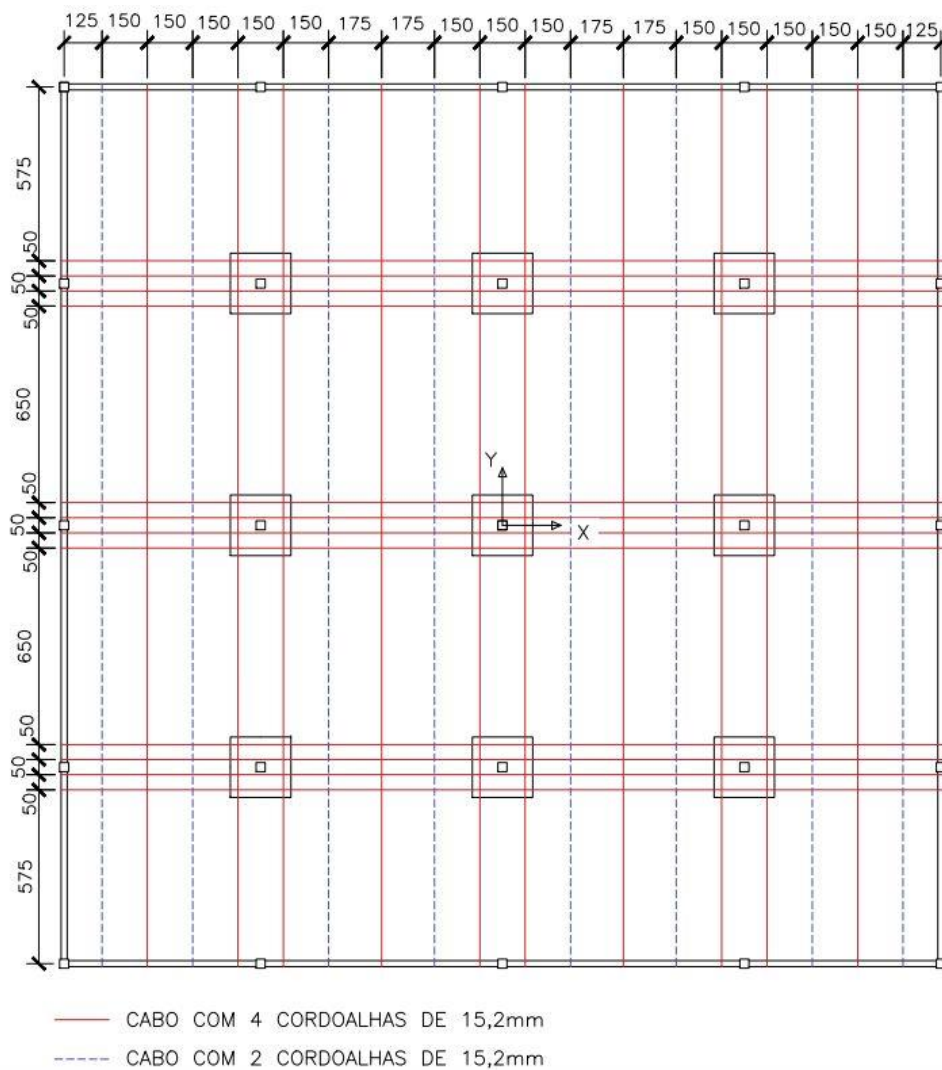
Planta da laje com disposição dos cabos e com a definição do eixo global de referência (dimensões em cm).
